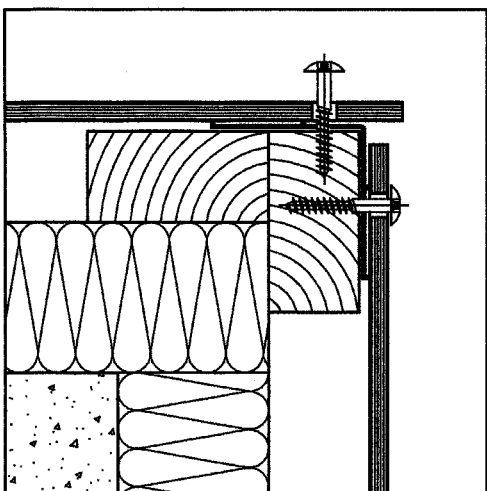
angle extérieur (vue en coupe horizontale)
